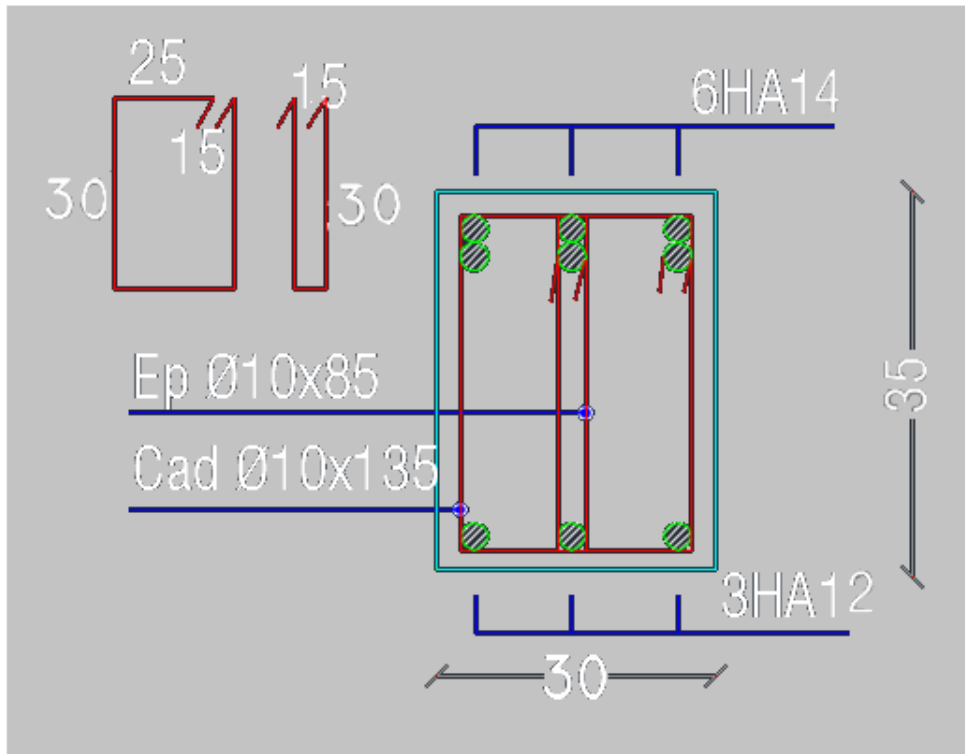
Ferrailage des poutres secondaires au niveau d'appuis de niveaux 14<sup>ème</sup> et 15<sup>ème</sup> étage.
